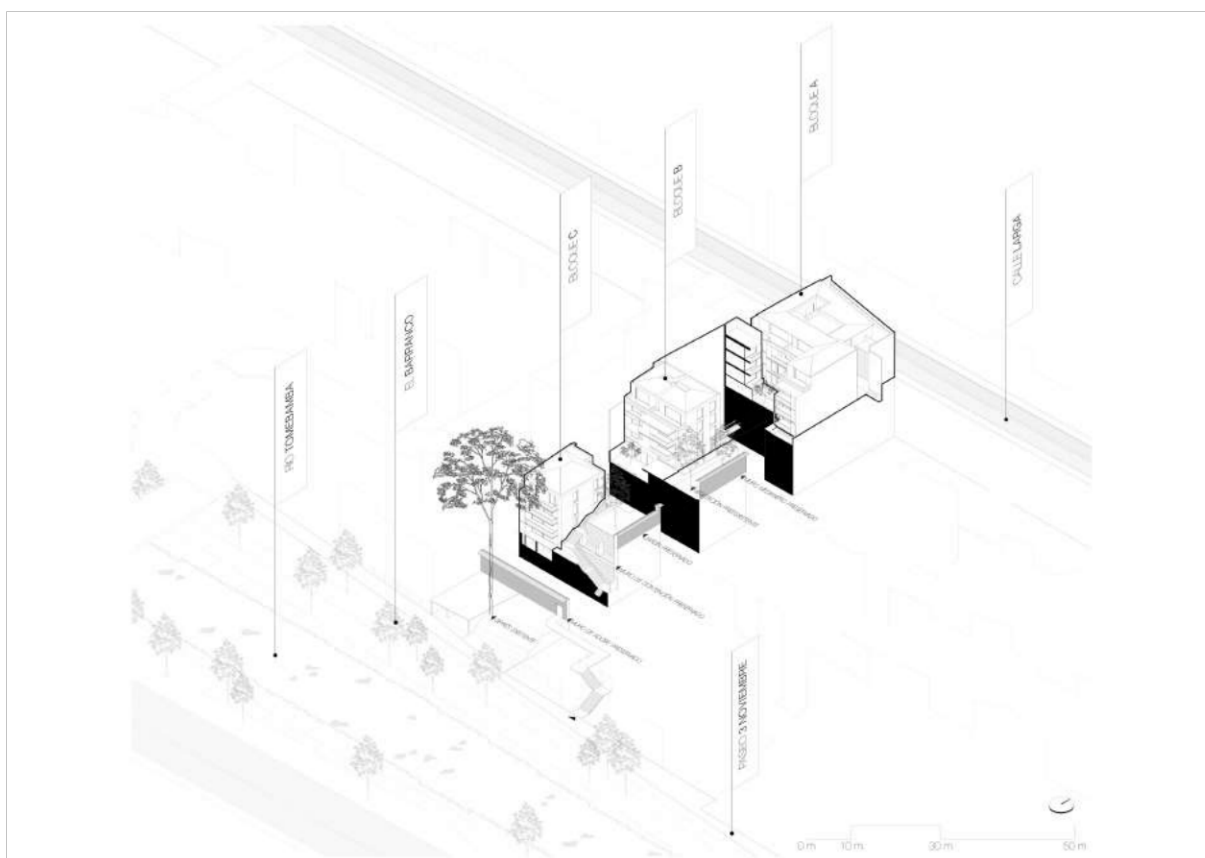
Bloques del edificio mediante la propuesta de reemplazo o restauración
